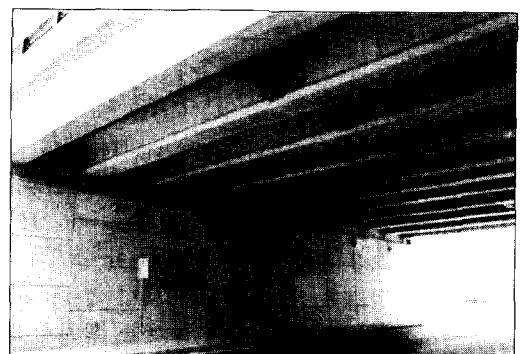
New England 벌브티의 교대와 세부사항을 볼 수 있는 Summer Street Bridge의 아래에서 본 사진
